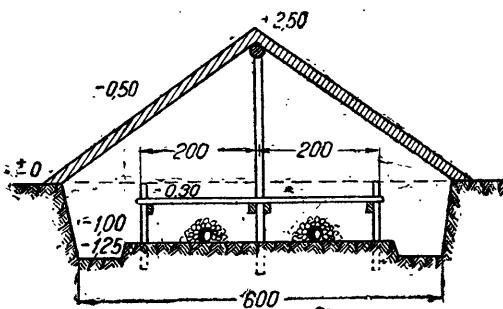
Система отопления углубленной землянки боровыми. Поперечный разрез по С—Д
